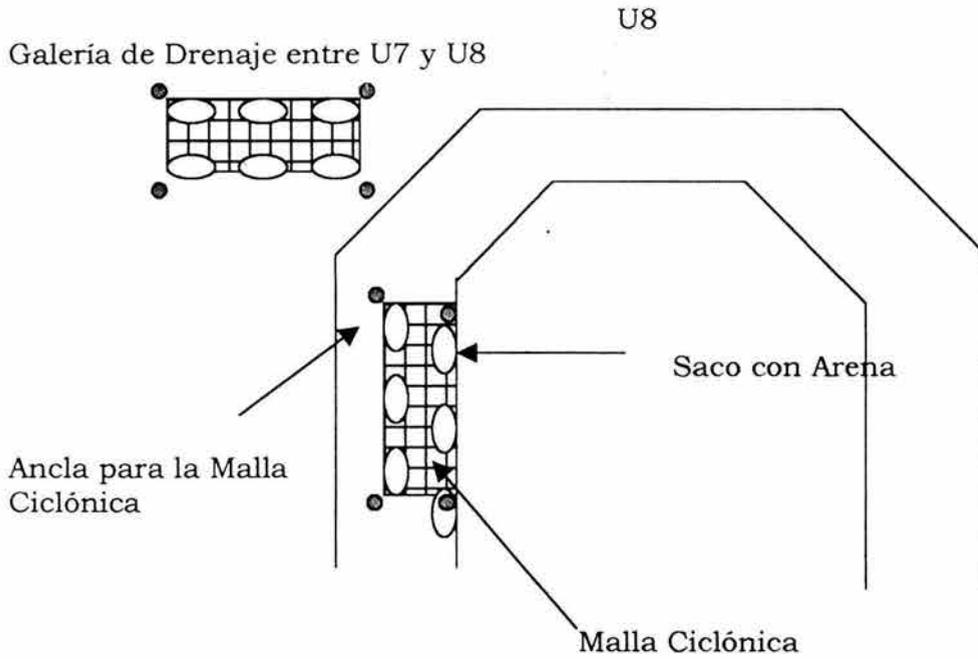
Foso de la Unidad 8 Vista en Planta
